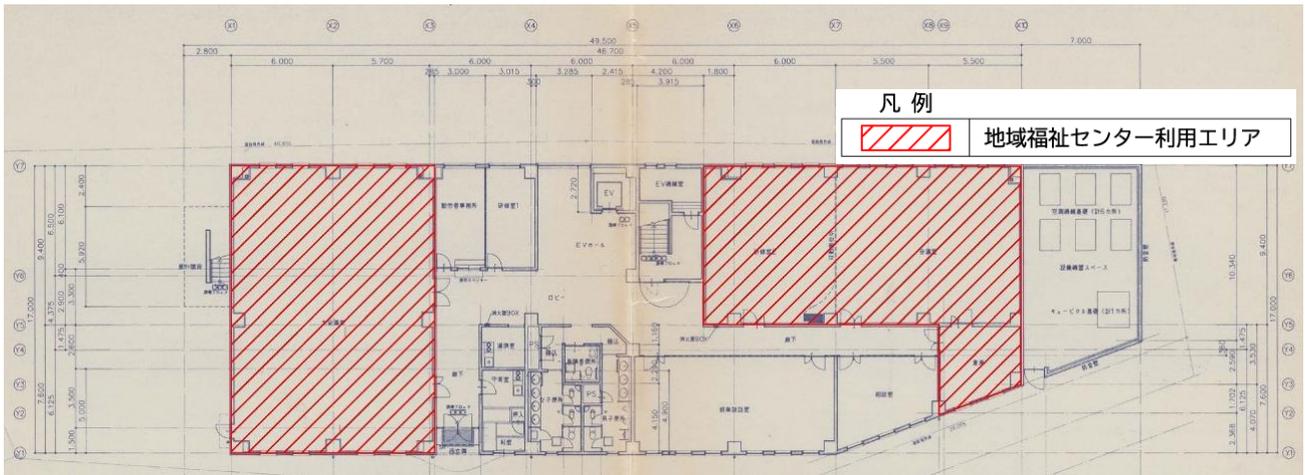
地域福祉センター 機能位置図 (案) 1階平面図
